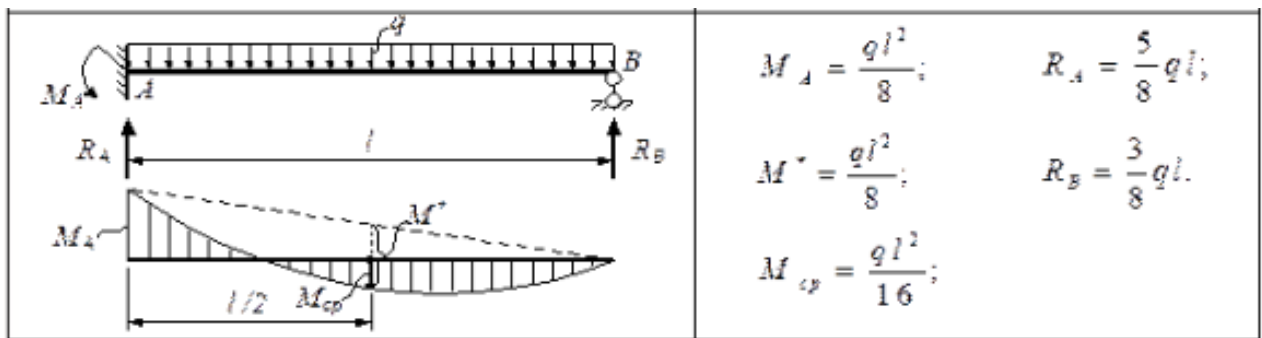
Схема работы конструкции при жёсткой заделке одного конца и шарнирном другом (схема работы после демонтажа)
